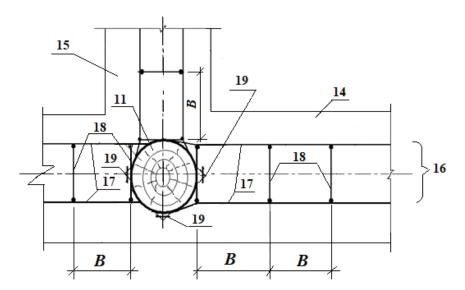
Фрагмент обустройства армирующей сетки в саманной кладке: 14, 15 — блоки ограждающих и поперечных стен; 16 — армирующая плетенная сетка; 17 — полимерные шнуры; 18 — распущенные камыши; 19 — скрутки
